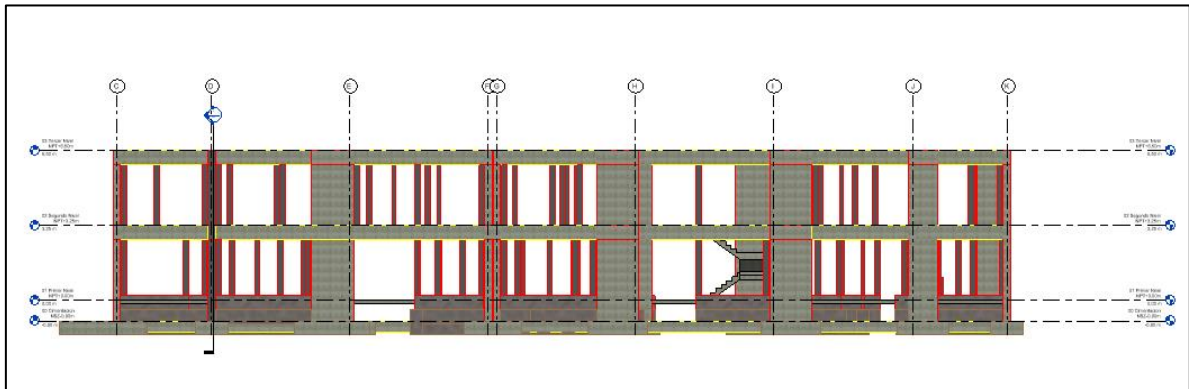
Vista principal de eje 12A – modelo de Estructuras
